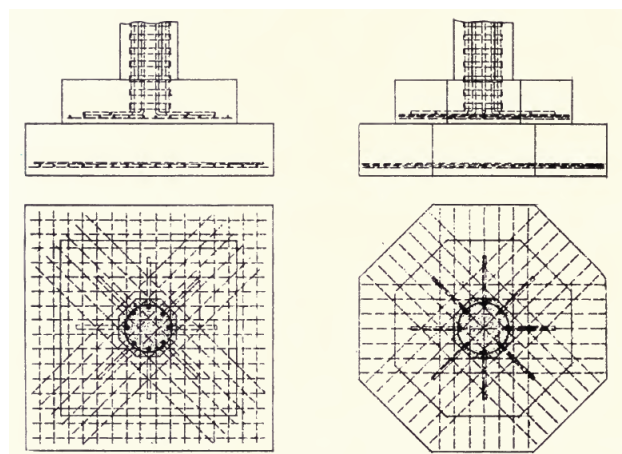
Zapatas aisladas compuestas. Eddy et al. [6].
